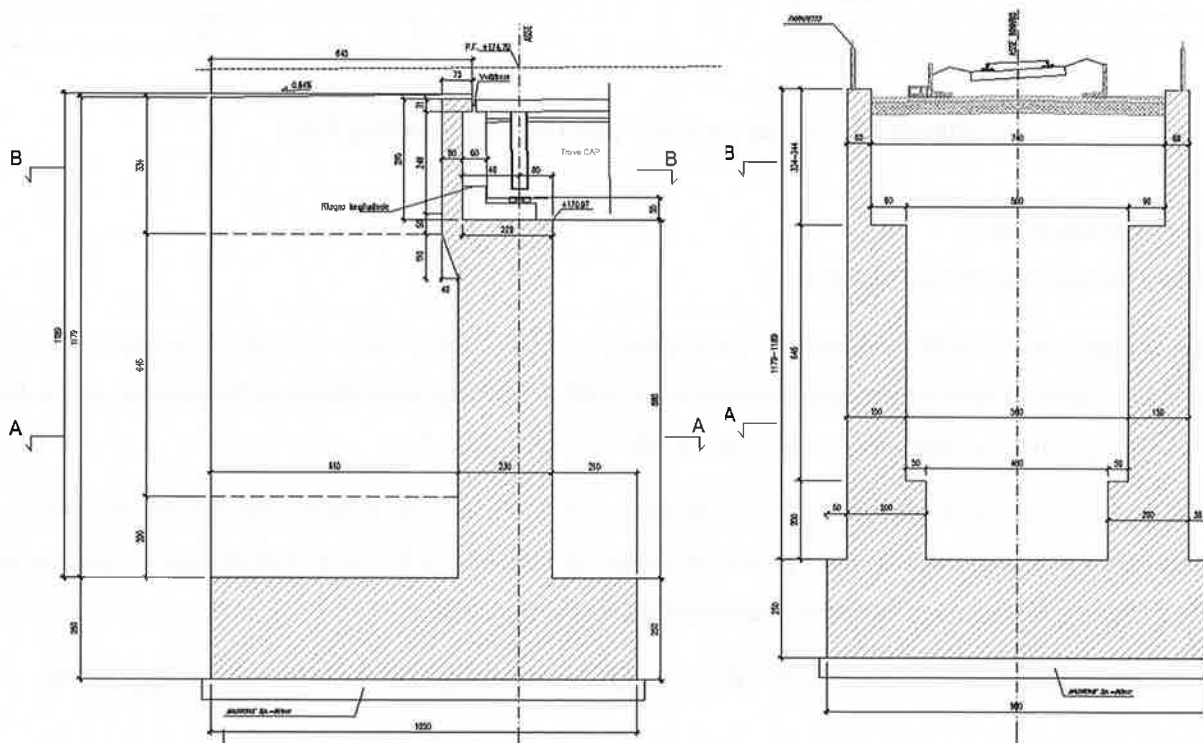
Sezione longitudinale e trasversale spalla A Bauladu VI02
